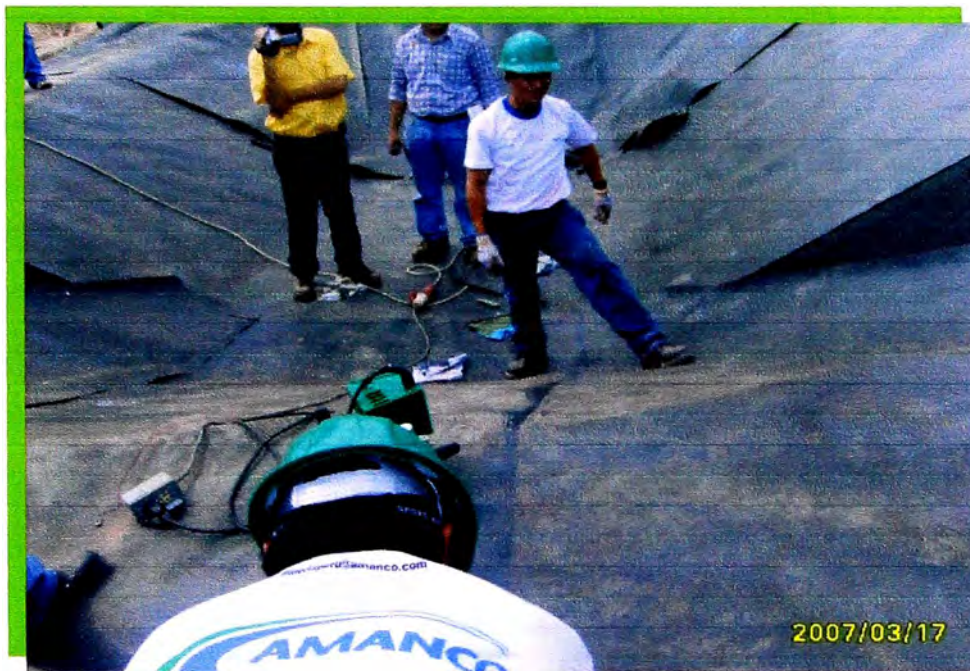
Proceso de soldadura por termofusión con la cuña caliente.
